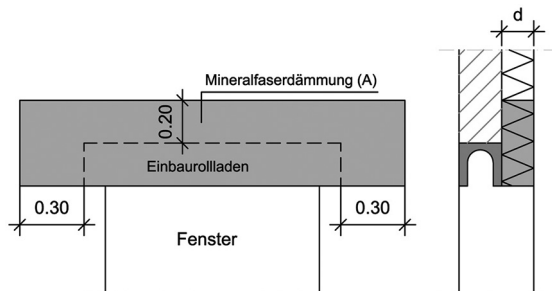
Einbaurollladen – im Neubau eingebaut (Quelle: C. Uske)
